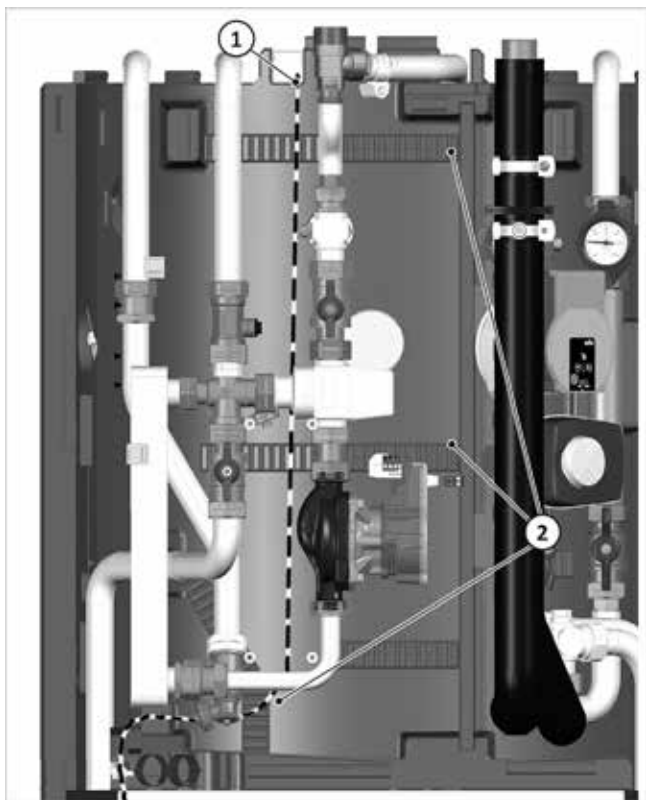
guidage de la conduite à travers l'isolation de la station d'eau chaude
